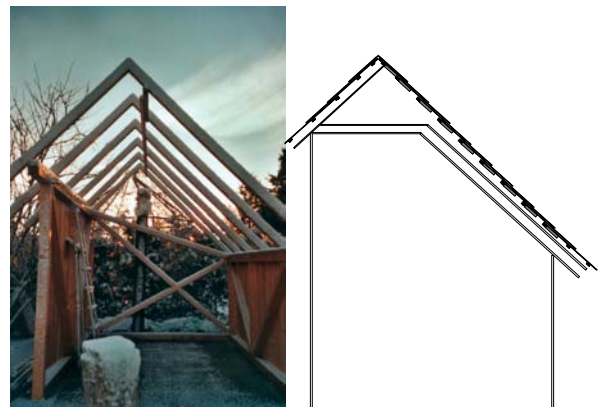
Gartenhaus im Bau und Skizze der Luftführung und der Wärmedämmung unter den PV/T-Schiefern.
